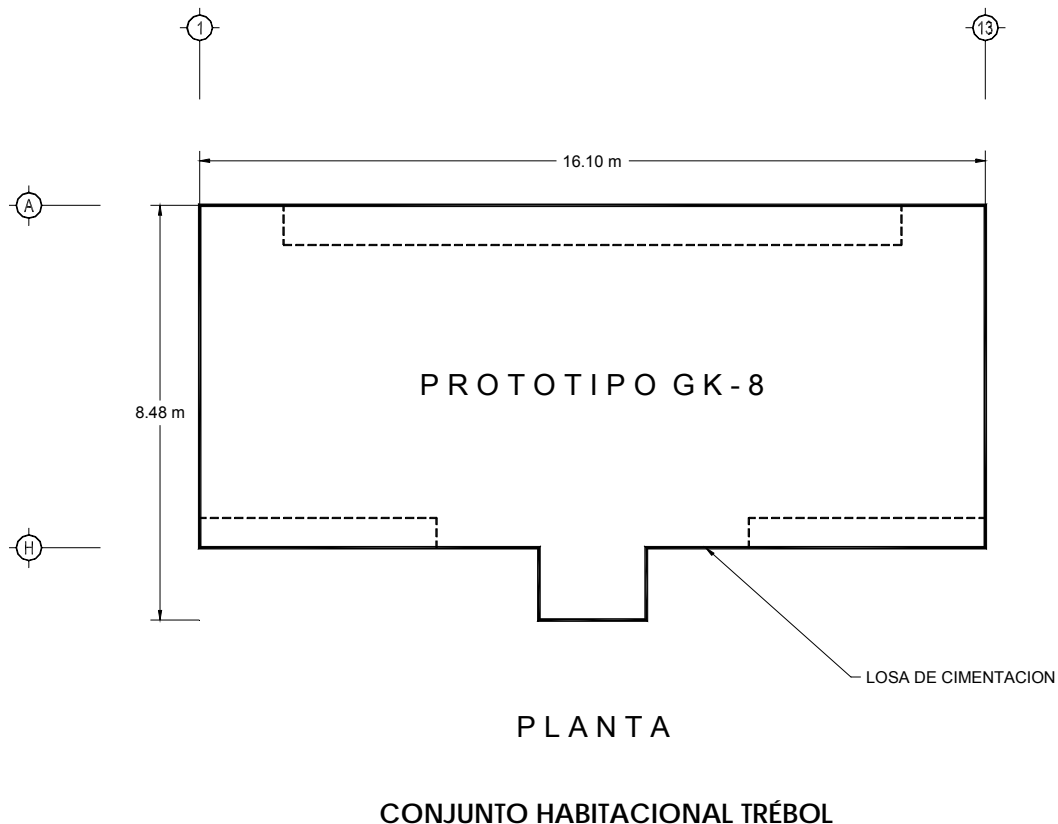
Traza de la losa de cimentación del prototipo GK-8
